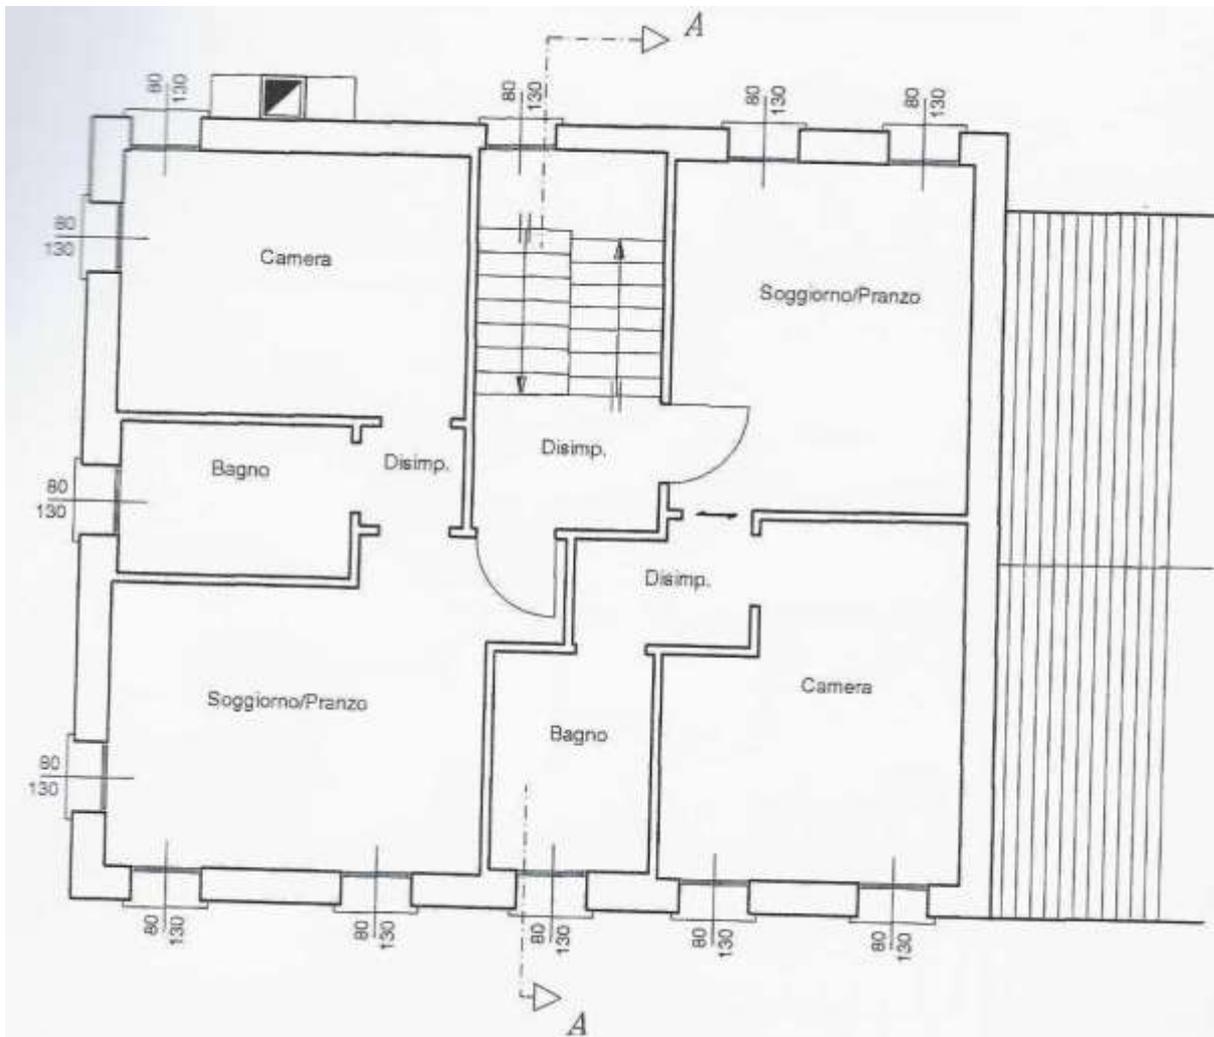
PIANTA PIANO TERRA (fuori scala)
